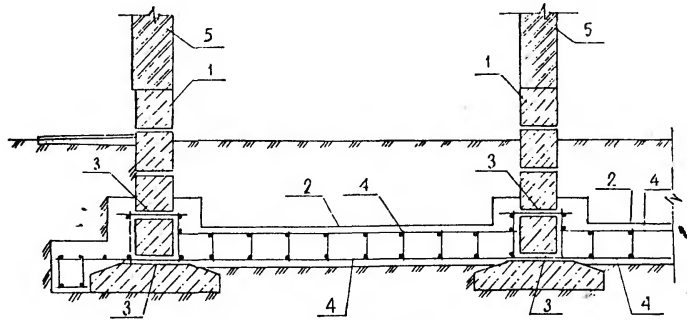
Устройство сплошной (прерывистой) плиты наращиванием сверху подушек
